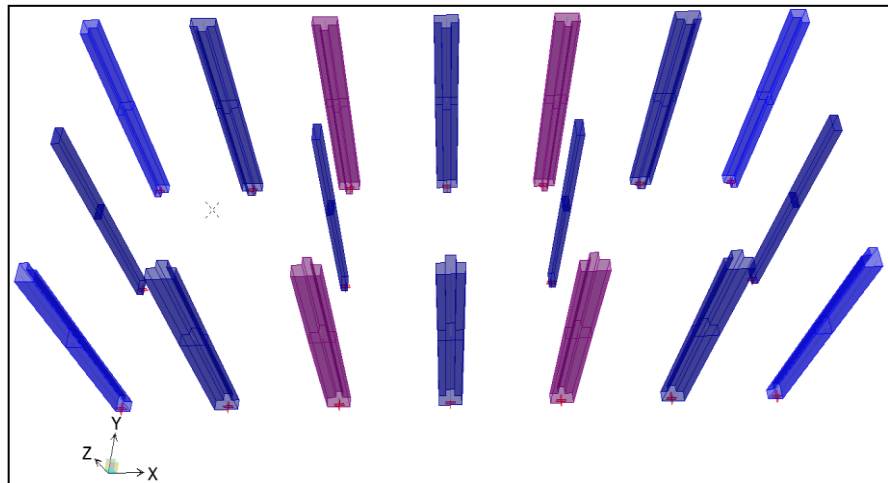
Nomenclaturas asignadas a las columnas del pabellón 1
